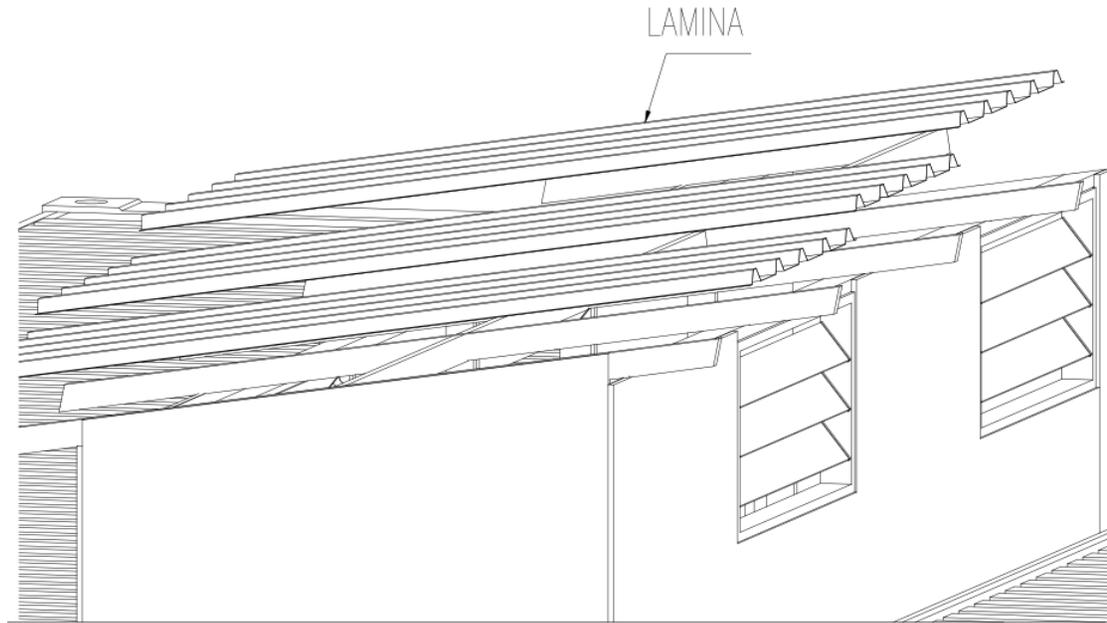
Detalle de Polineado para Estructura de Cubierta
